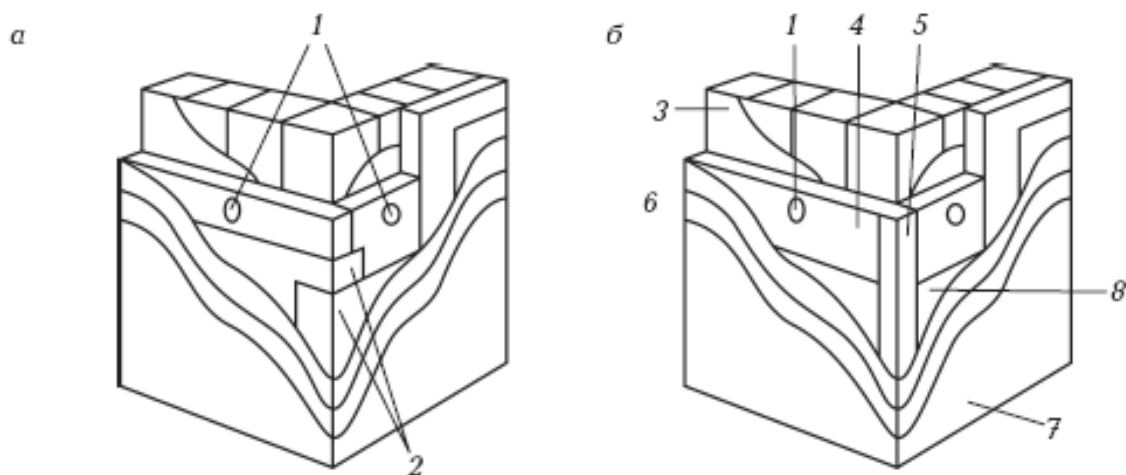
Отделка наружных углов стен: а) с использованием только армирующей сетки; б) с использованием армирующей сетки и углового профиля; 1 – дюбели; 2 – полотна армирующей сетки с нахлестом; 3 – клей для крепления утеплителя; 4 – утеплитель; 5 – угловой профиль; 6 – раствор для выполнения армирующего слоя; 7 – армирующая сетка; 8 – штукатурка
